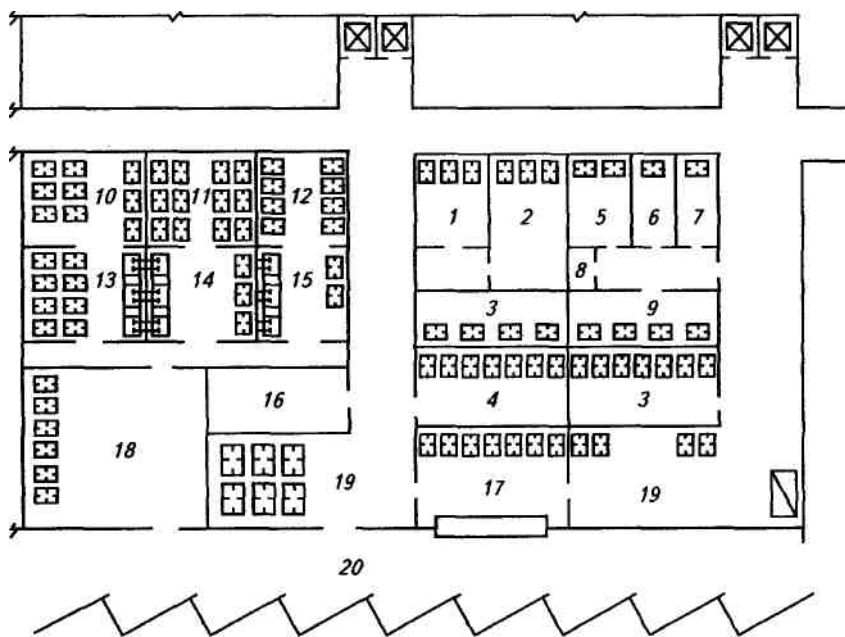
Планировка экспедиции заготовочного предприятия:
